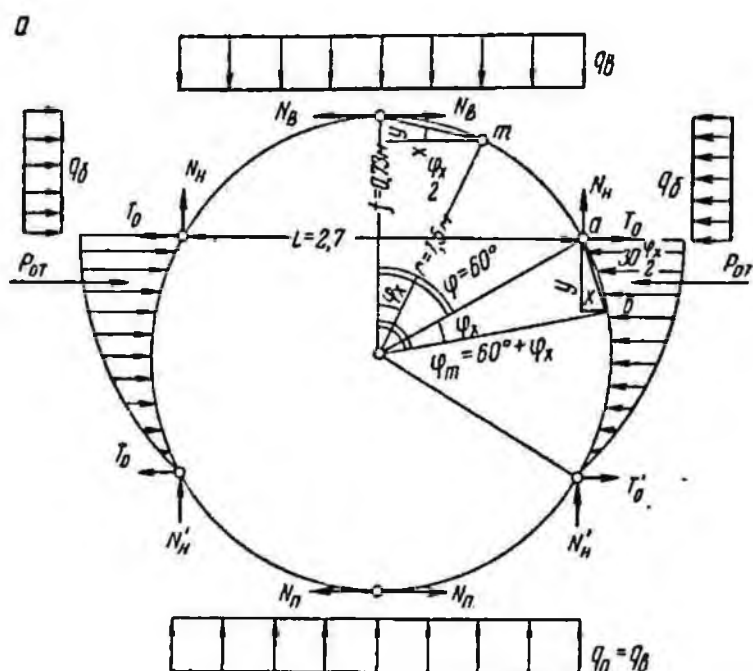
Расчетная схема и эпюры крeпи ГГК
